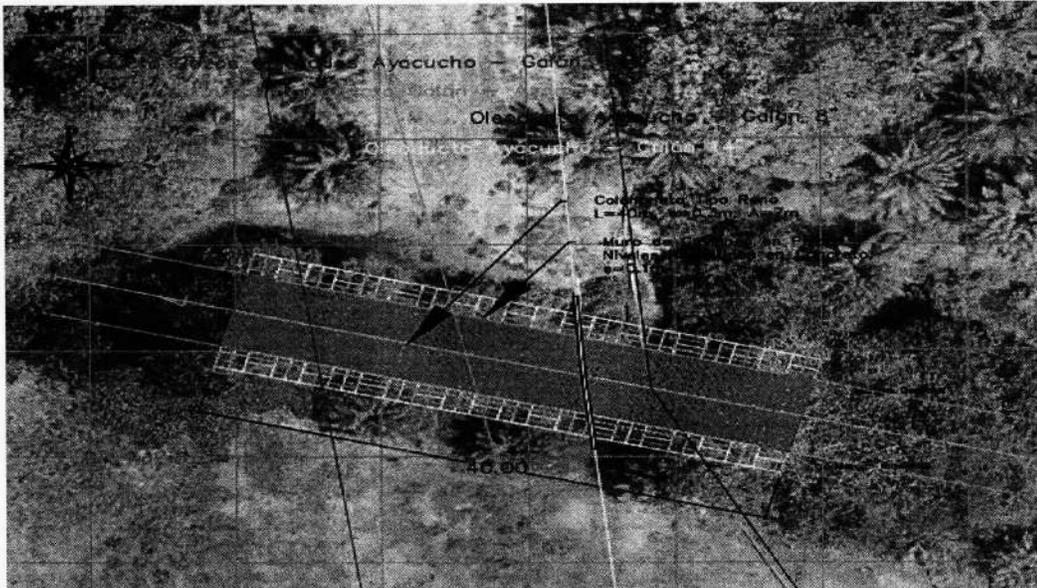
Esquema en planta de las obras ejecutadas en el Caño La Llana, en el cruce subfluvial del Sistema de Transporte de Hidrocarburos Ayacucho – Galán 14” (PK 99+550).
